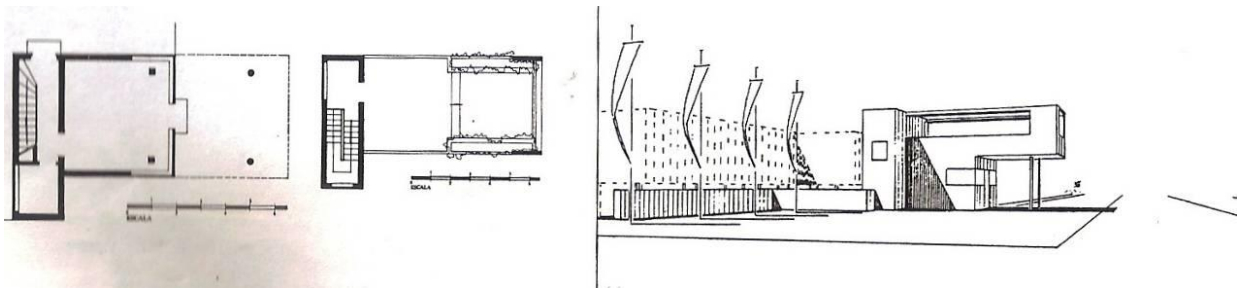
Grundriss des Erd- und Obergeschosses und Ansicht der Torgebäude der 45. Straße.
